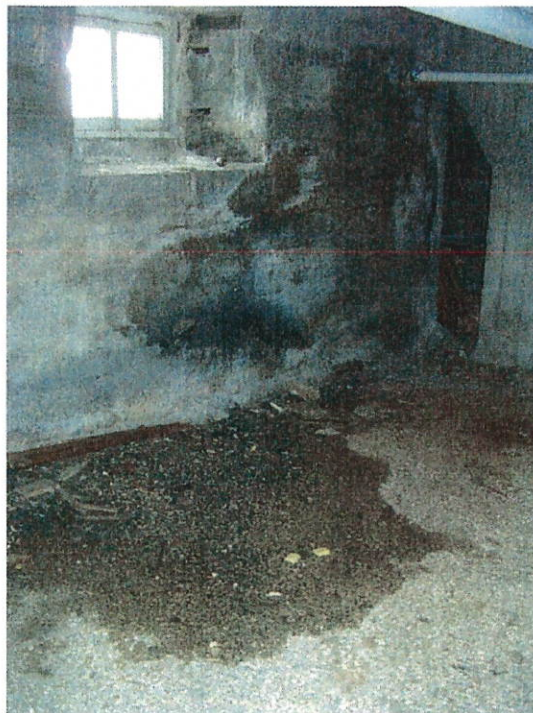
Murs de fondation - Infiltration d'eau (sol et béton humide)
